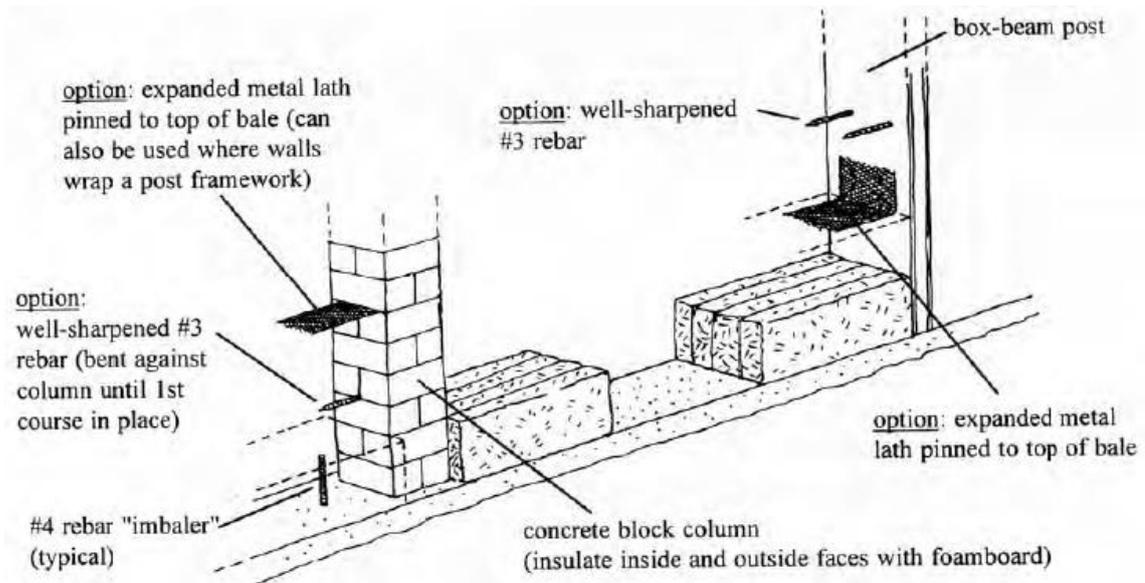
Exemplos de Fixação dos Fardos de Palha em Estruturas de Concreto e Metálicas
